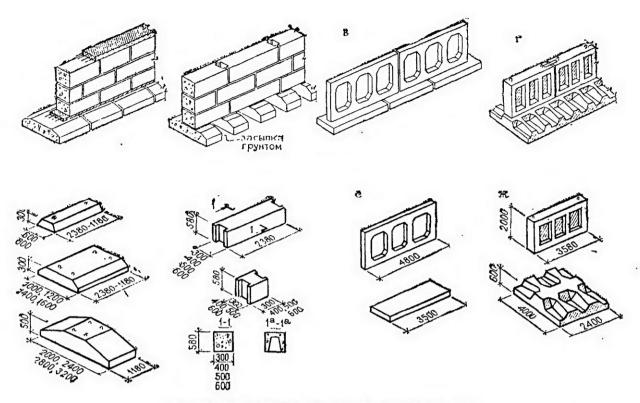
Сборные бетонные и железобетонные фундаменты
